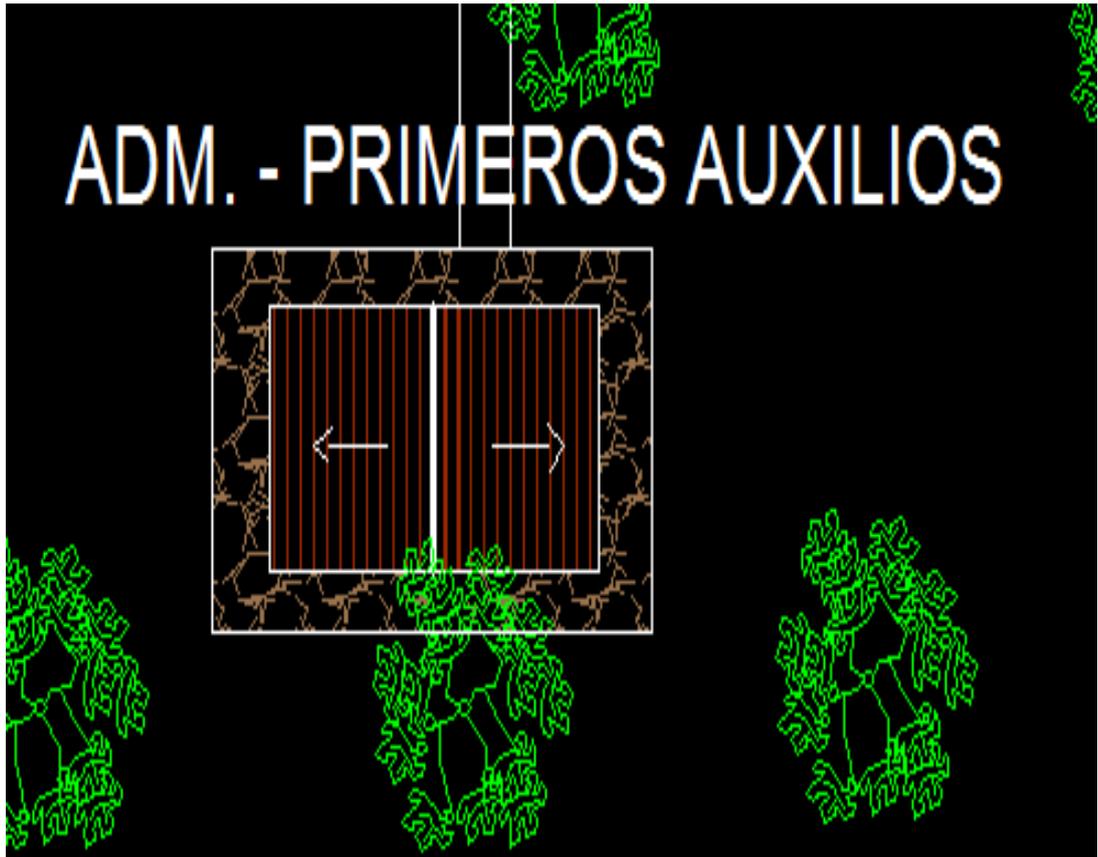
Cerramiento de acero y muro de hormigón.
